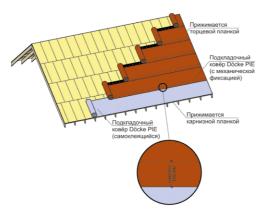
Схема расположения подкладочного ковра Döcke (последовательность укладки полотен в соответствии с п. 4.1.2).
